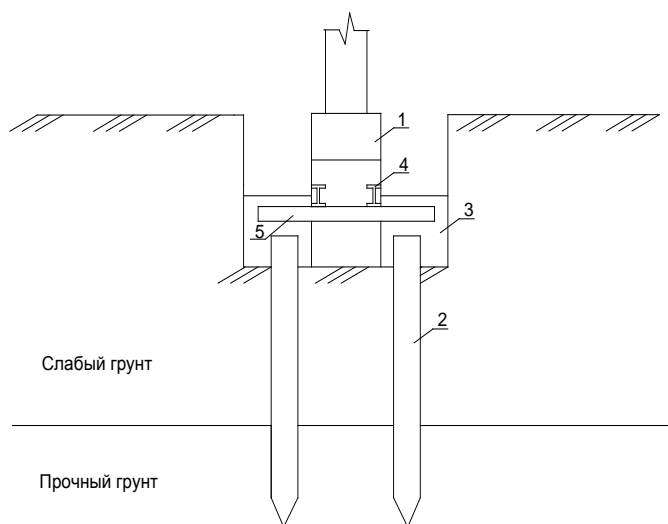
Усиление ленточного фундамента вдавливаемыми сваями:
